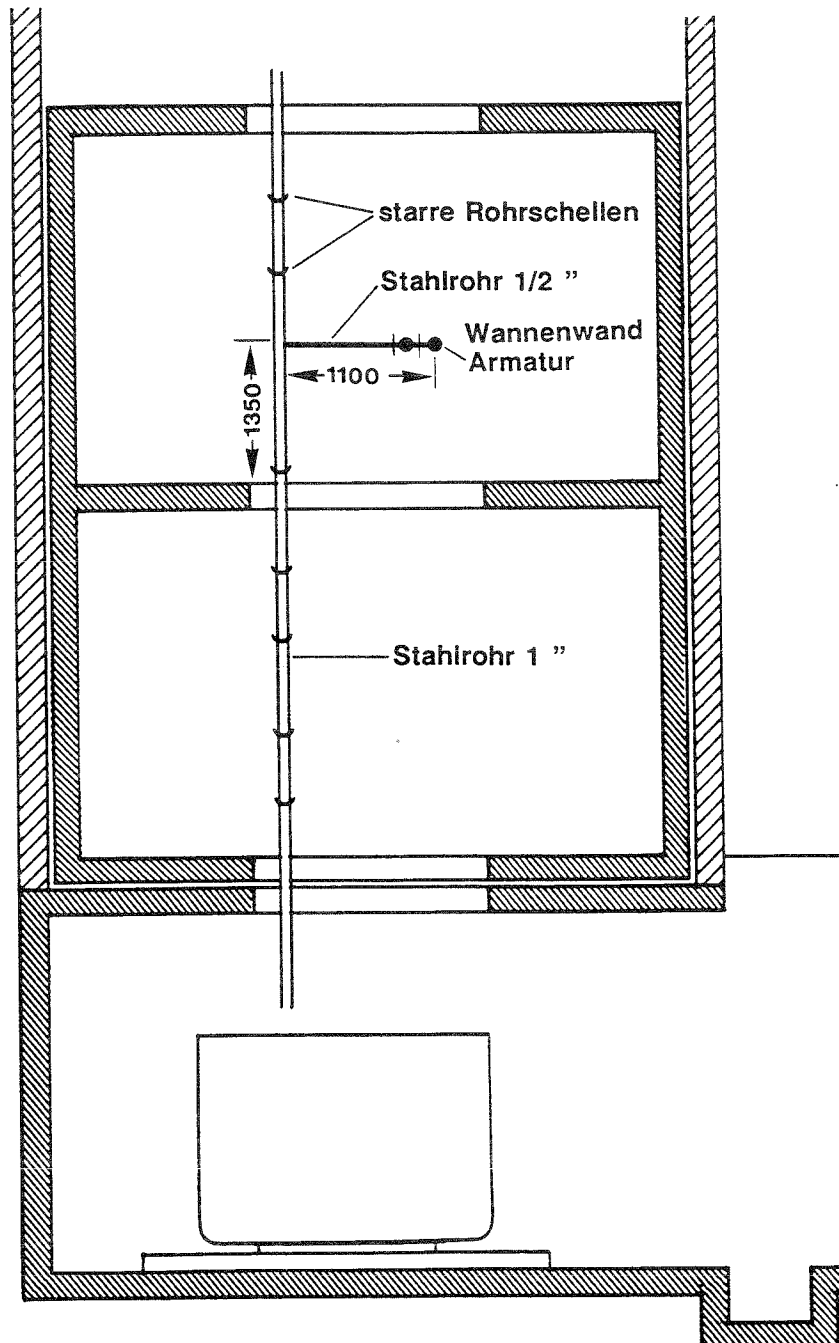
Musterinstallation im Installationsprüfstand für Wannenwandbatterie
